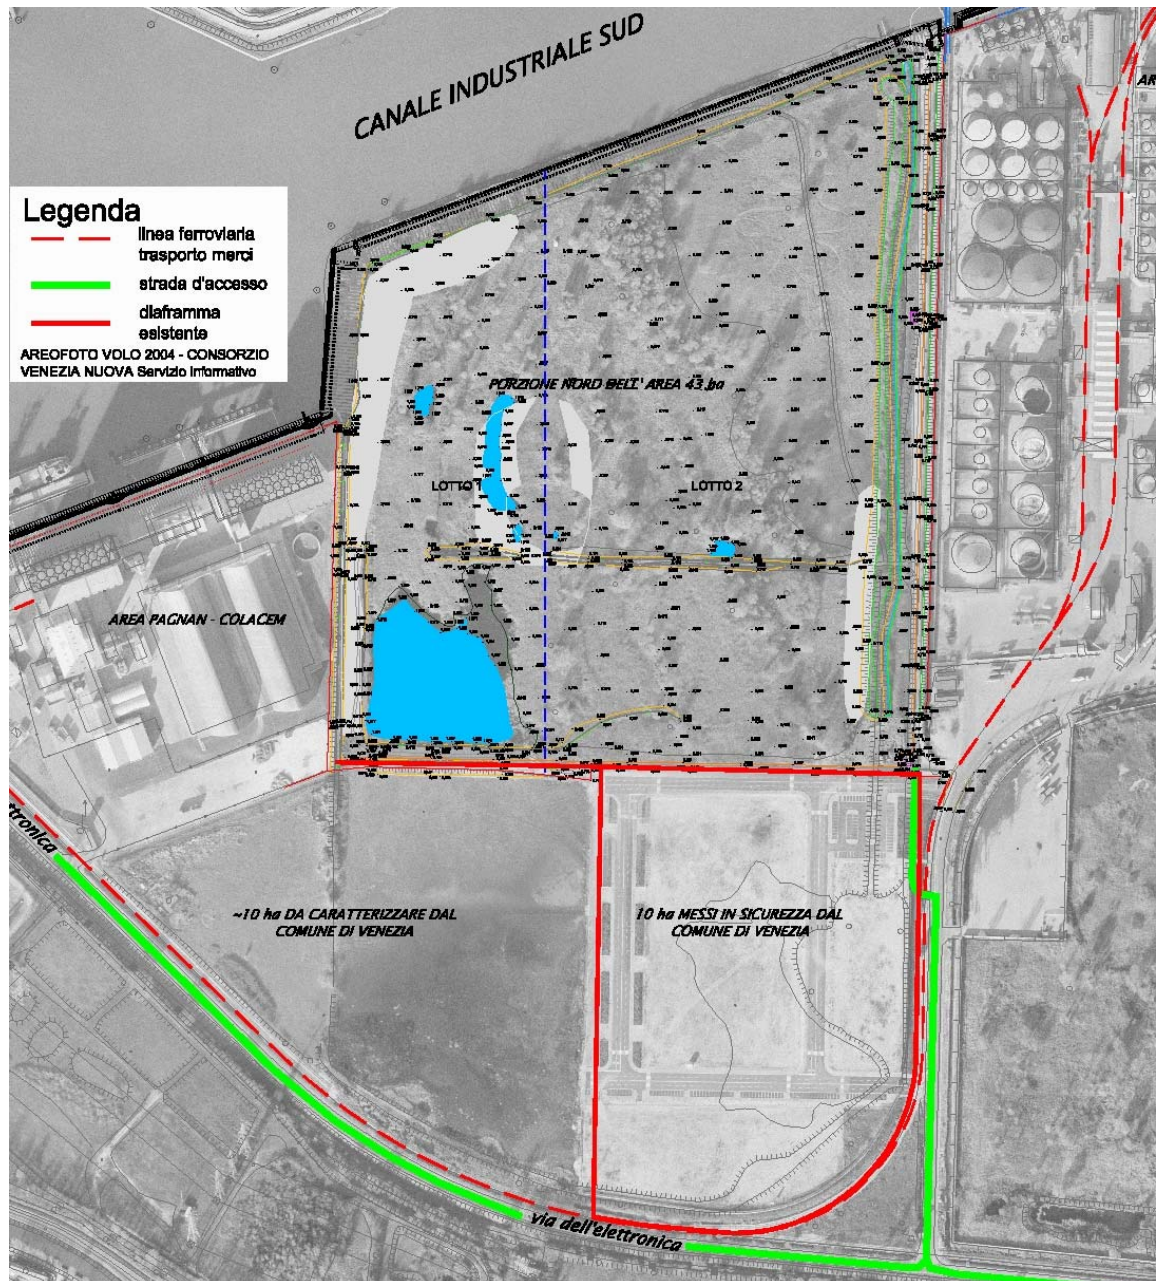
Planimetria con l'ubicazione delle diverse sub-aree: quella in progettazione a nord, quella del Comune di Venezia di sud-est già messa in sicurezza e quella di sud ovest da caratterizzare; la linea rossa continua rappresenta il tracciato planimetrico del diaframma realizzato dal Comune di Venezia.
